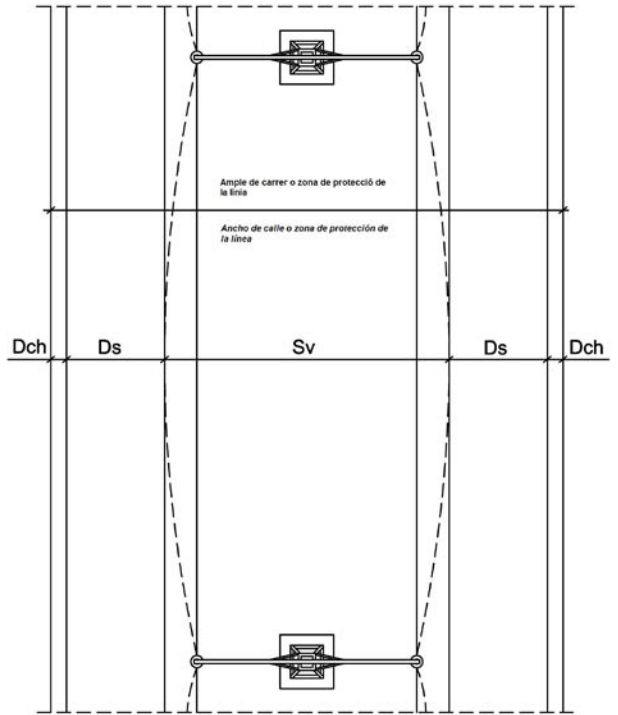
Planta tipo de la calle o zona de protección de la línea
